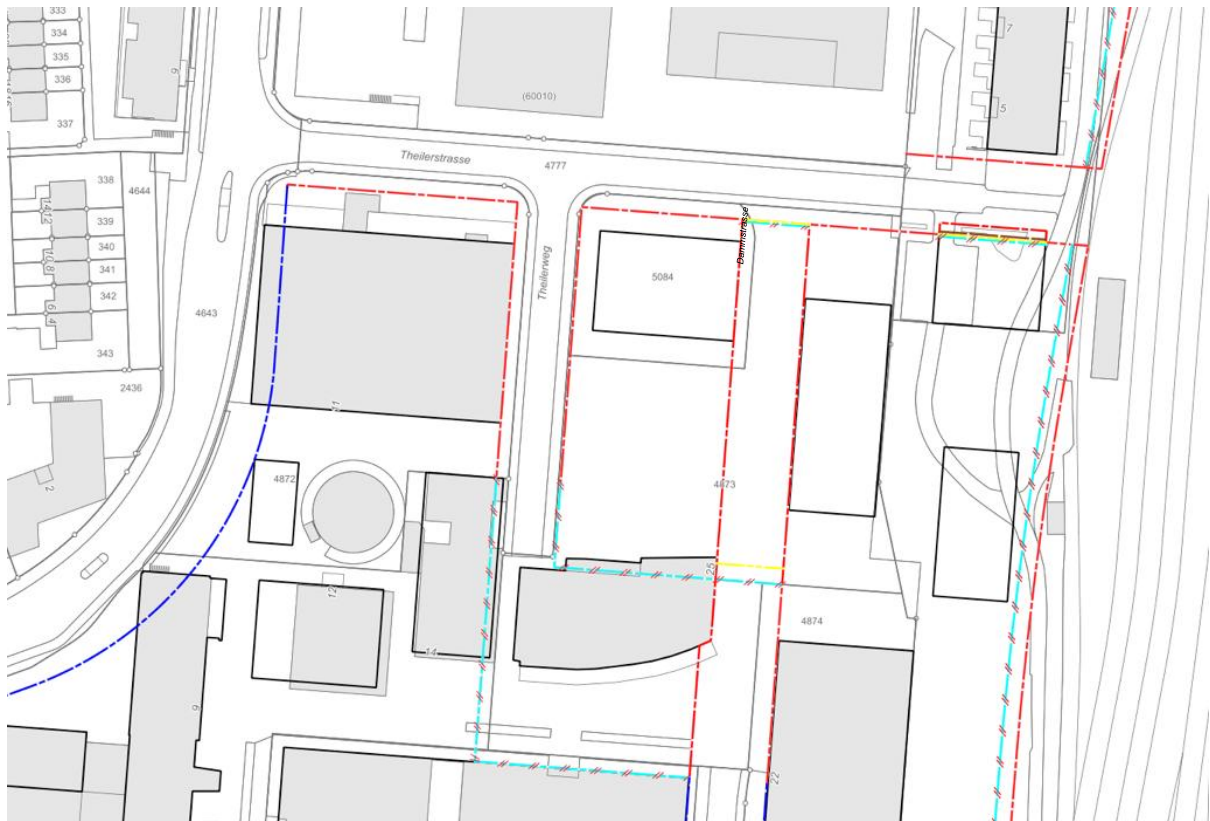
Ausschnitt Baulinienplan LG-Areal (Quelle: Stadt Zug, Stand 13. März 2026)
